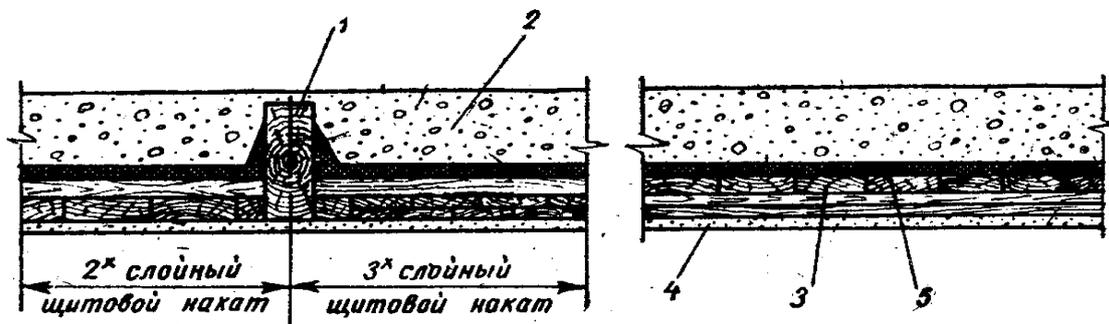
Чердачное перекрытие с щитовым накатом: 1 – балка; 2 – шлак; 3 – сплошной несущий поперечный настил; 4 – штукатурка; 5 – смазка
